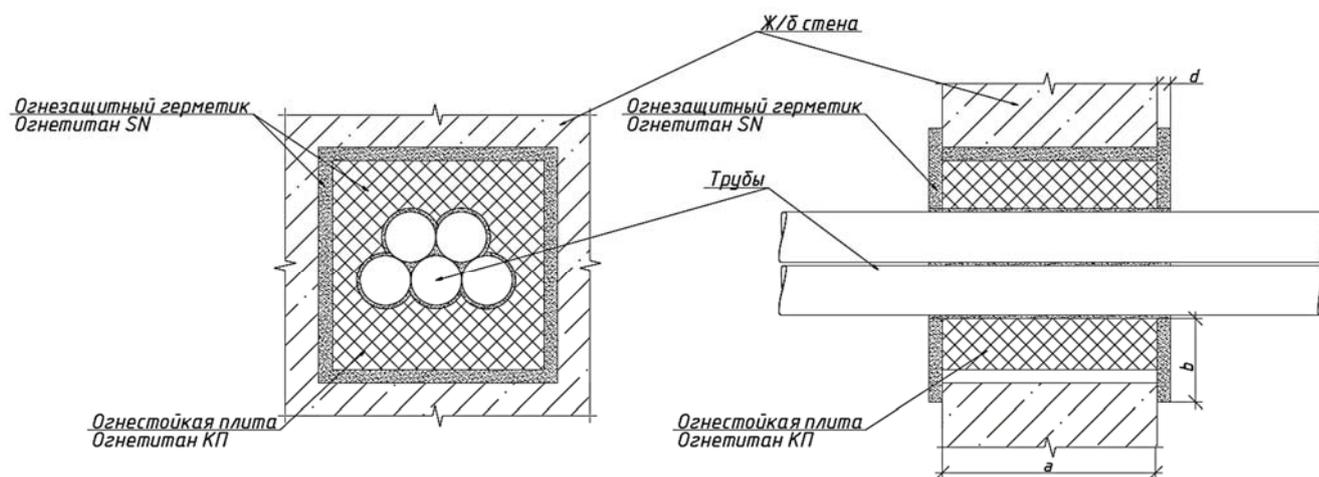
Огнестойкая заделка стальных металлических трубопроводов
